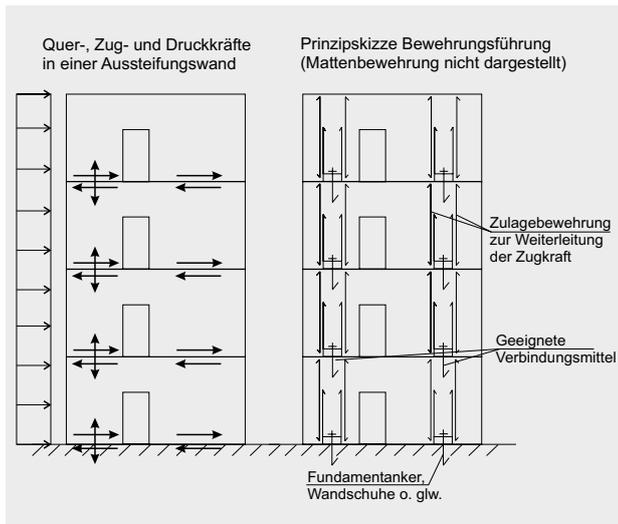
Schematischer Kräfteverlauf und Bewehrungsanordnung in einer aussteifenden Wandscheibe
